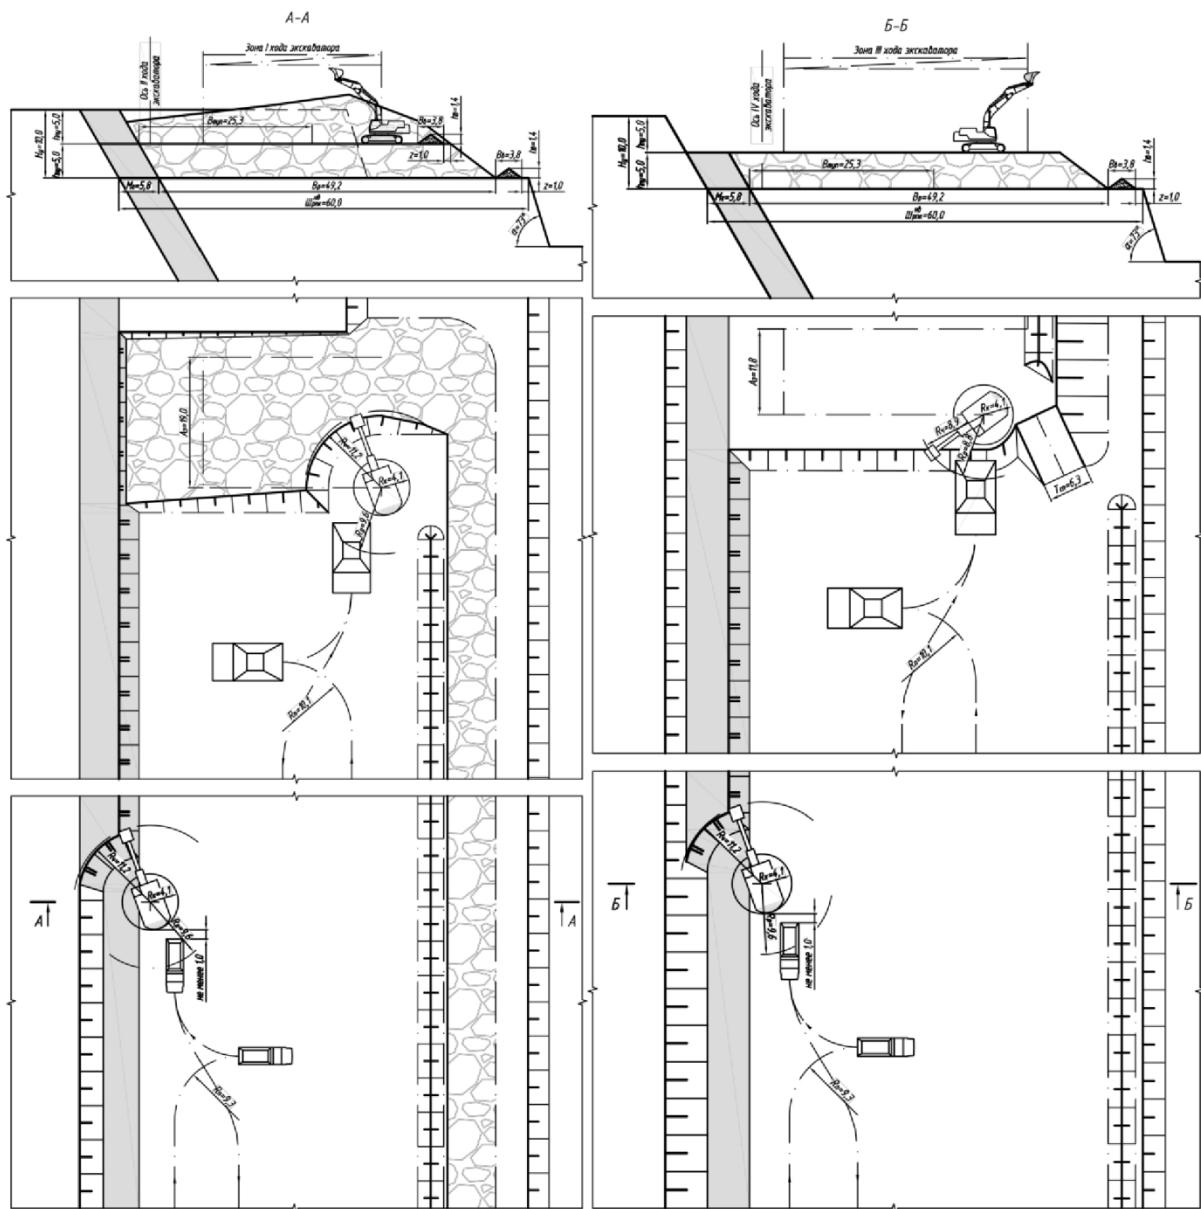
Схема проходки разрезной траншеи и отработки угольного пласта
